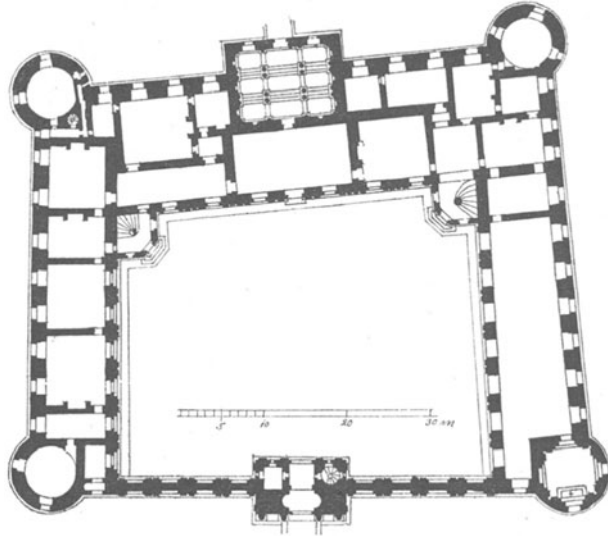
Château de Tanlay. Grundriss des Rez-de-chaussée.
